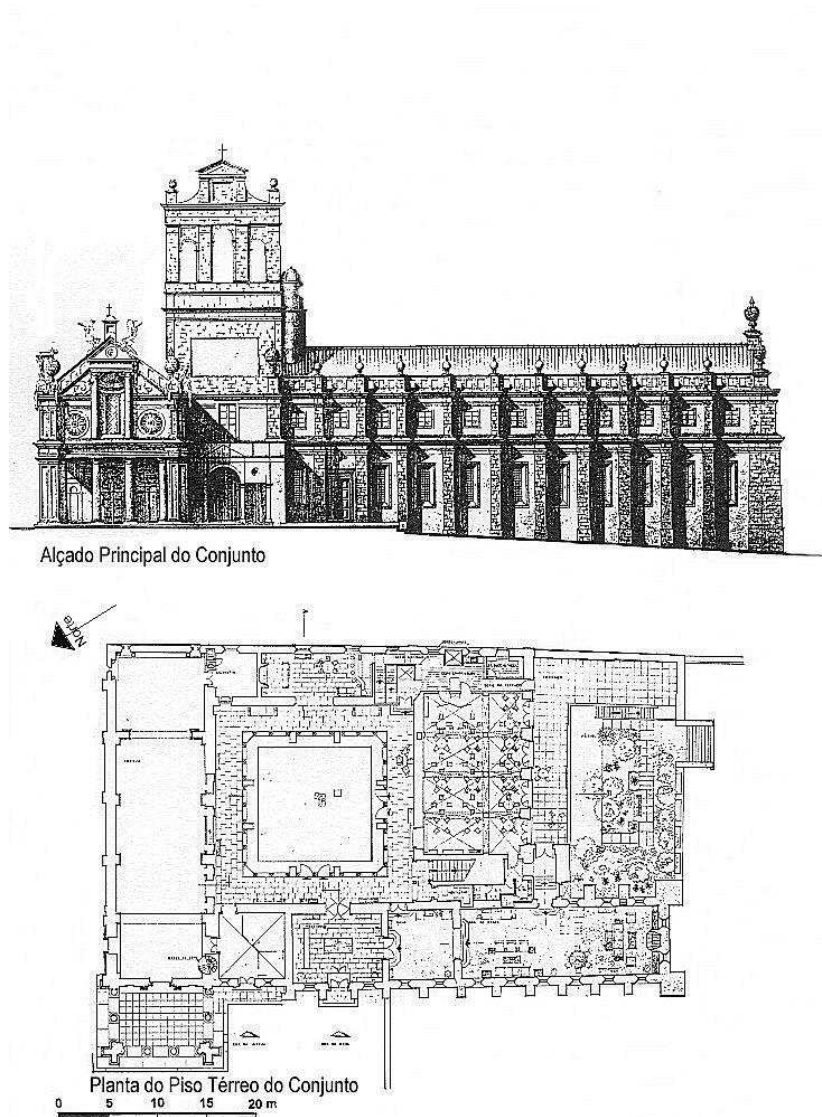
Alçado principal e planta do conjunto monástico de Nossa Senhora da Graça.
